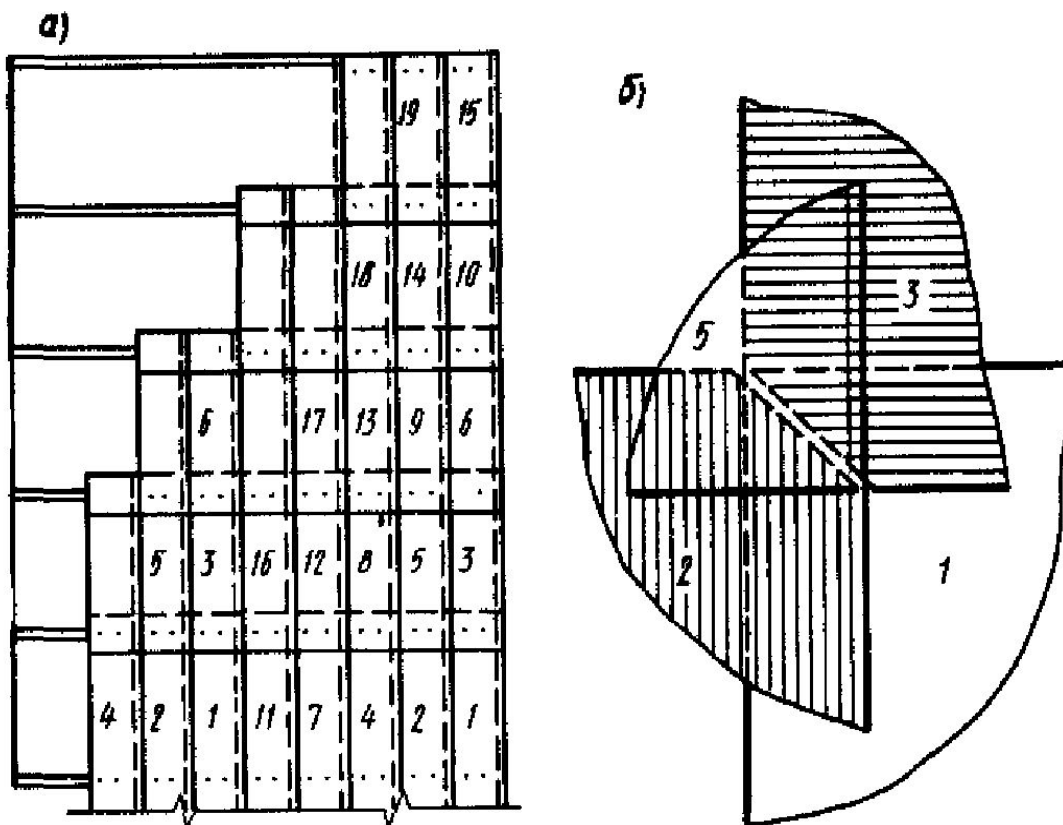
Рекомендуемый порядок укладки асбестоцементных листов на крыше
